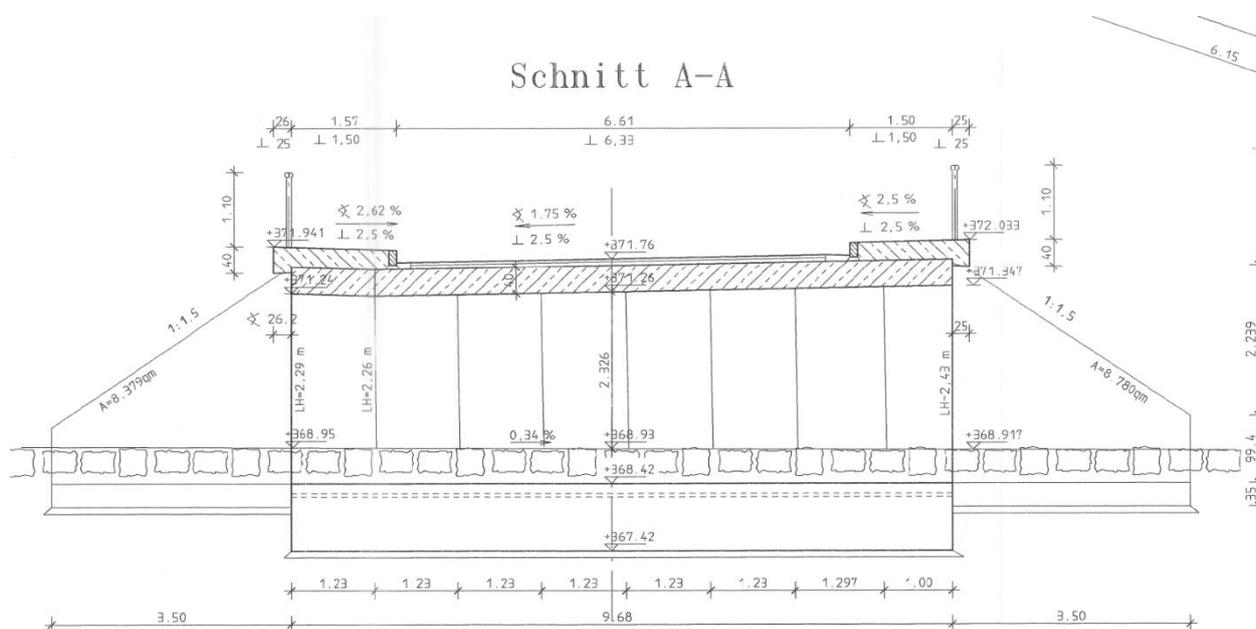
Querschnitt Brücke Hauptstraße (Bestandsplan, LRA AÖ)
